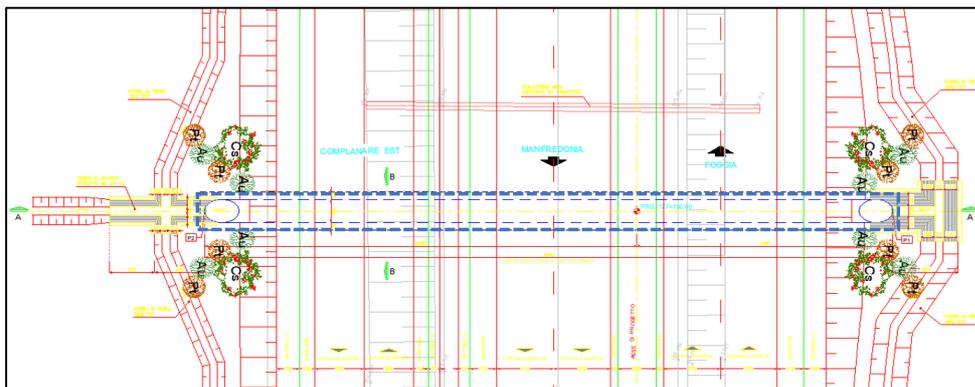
Dettaglio planimetrico del sottopasso faunistico
